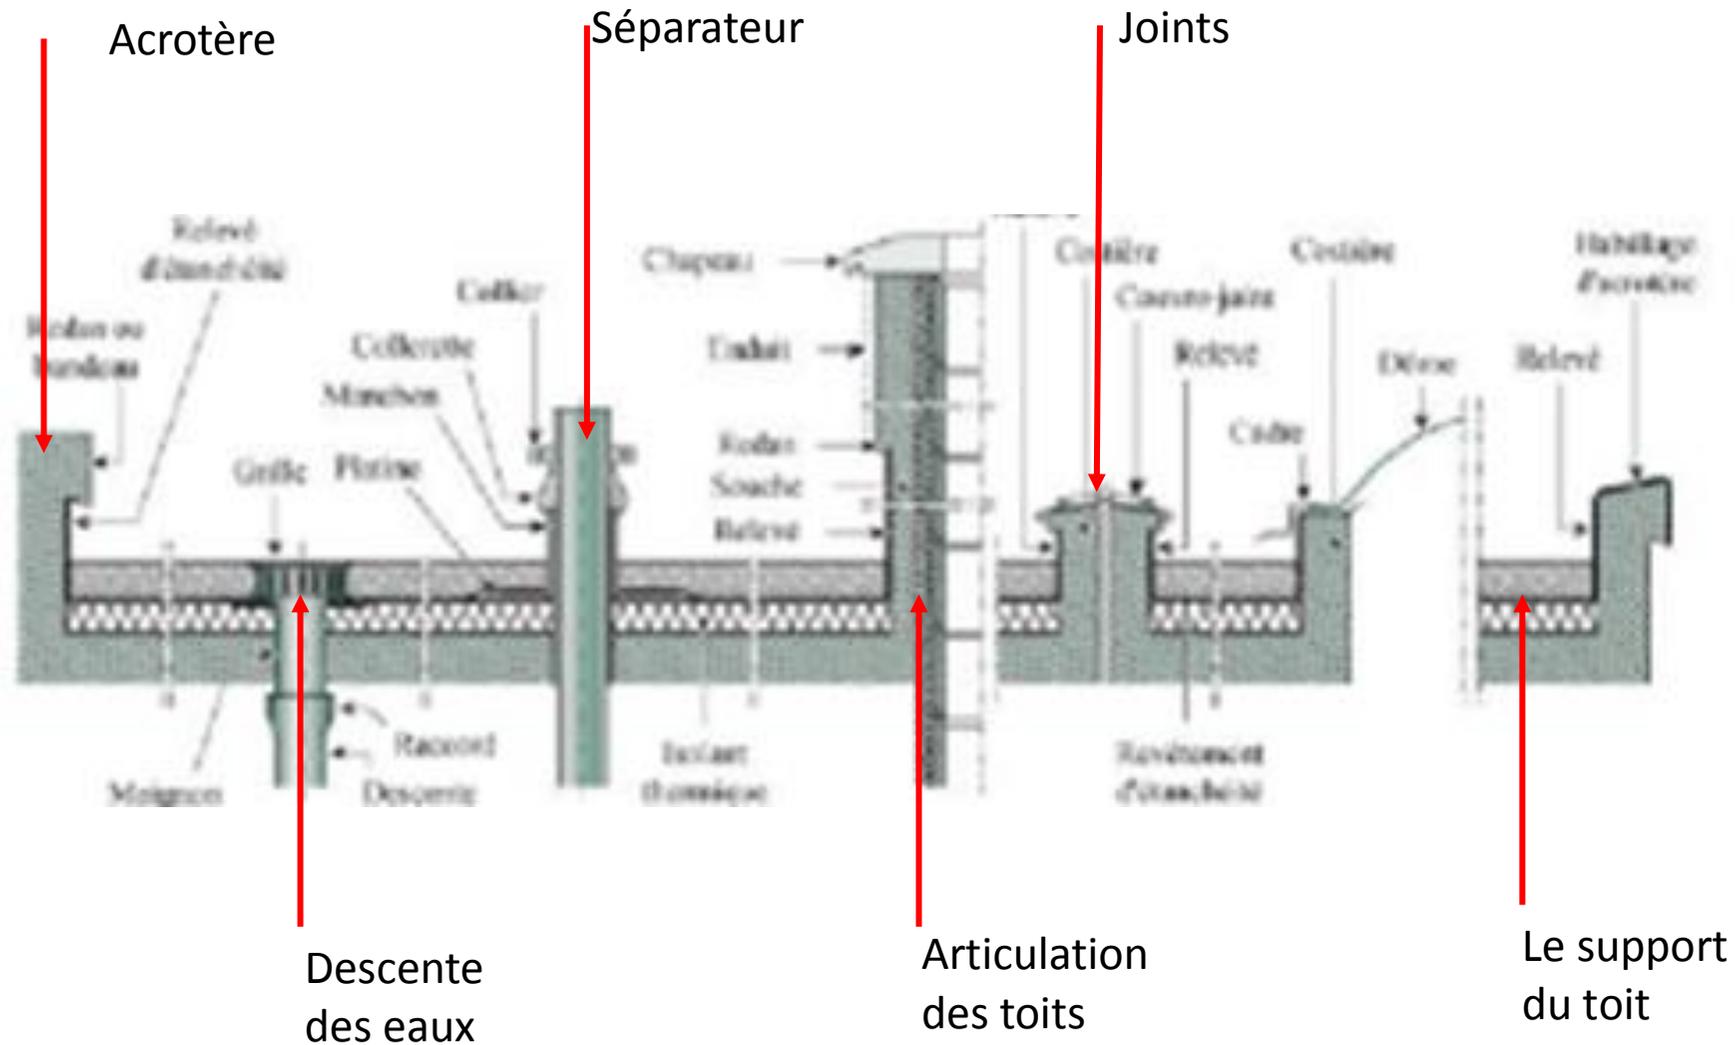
Les éléments constituant un toit terrasse et son étanchéité (Coupe)
